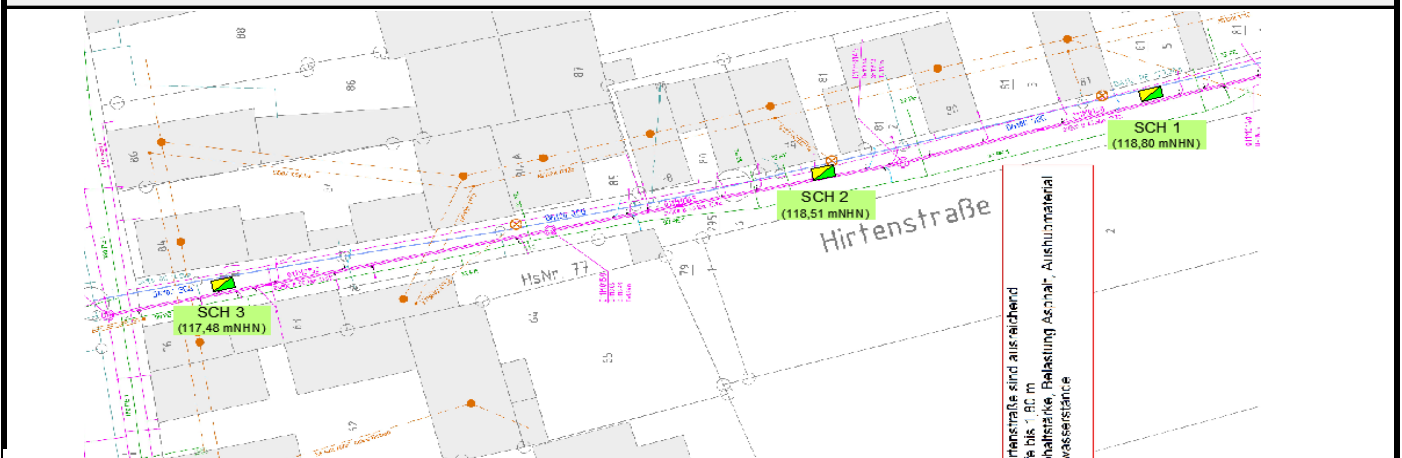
Lageskizze der Baumaßnahme (s. Anlage 1 Lageplan)
